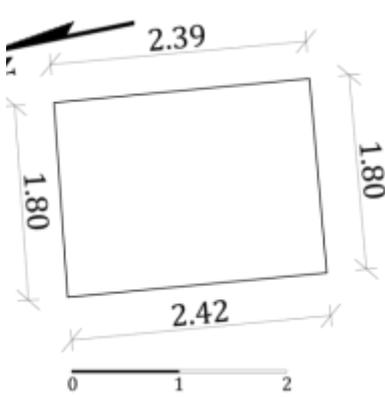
مسقط أفقي للمنور بدهليز المدخل بمسجد قايتباي بالمنيل (عمل الباحثة)
